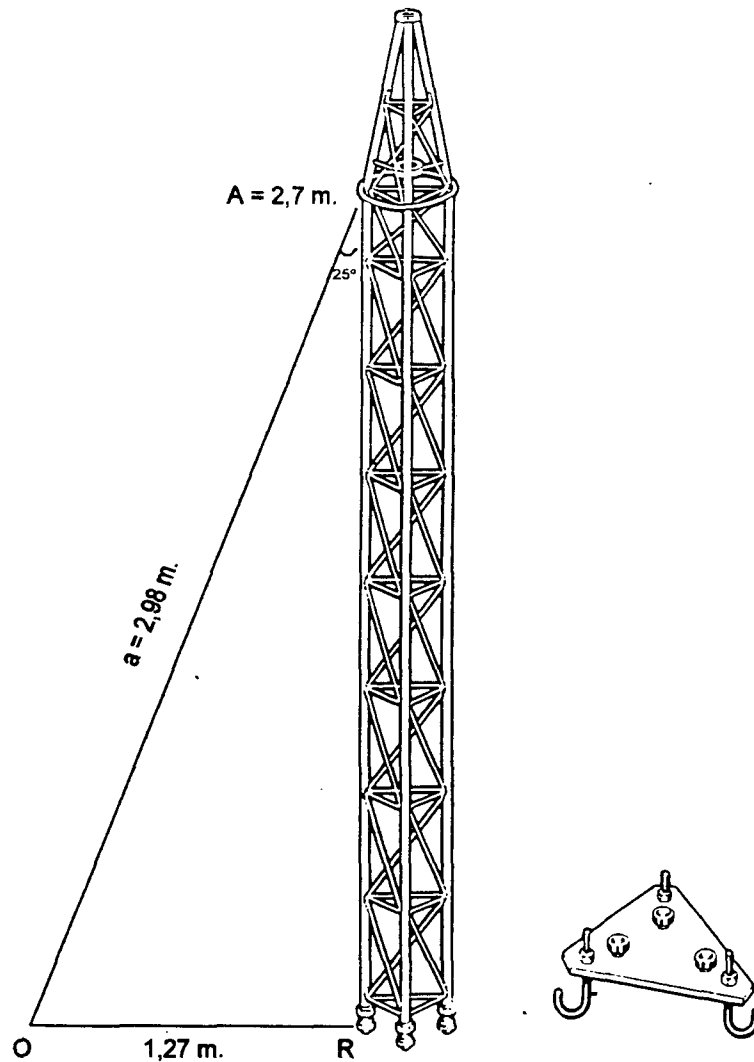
Zapata de Hormigón para la Torre y los vientos
